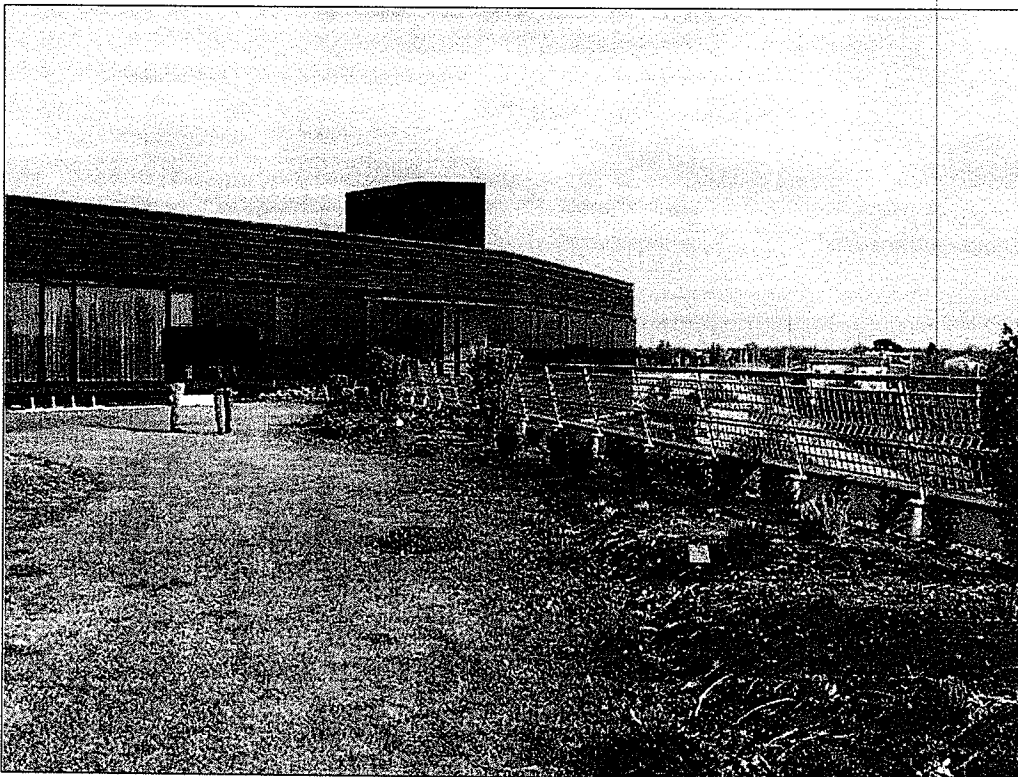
Il giardino pensile al primo piano, prospetto sud del fabbricato
